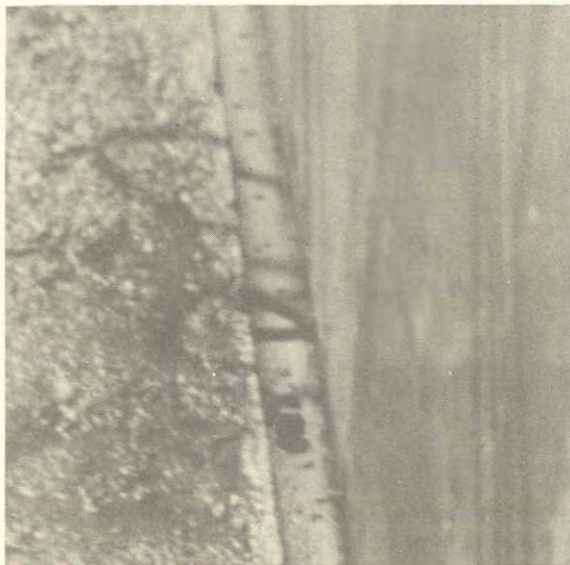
Aspecto do rebaixo, para a formação da junta seca entre camadas, após o levantamento das fôrmas. Observar que o rebaixo é mais largo do que profundo - Itaipu
